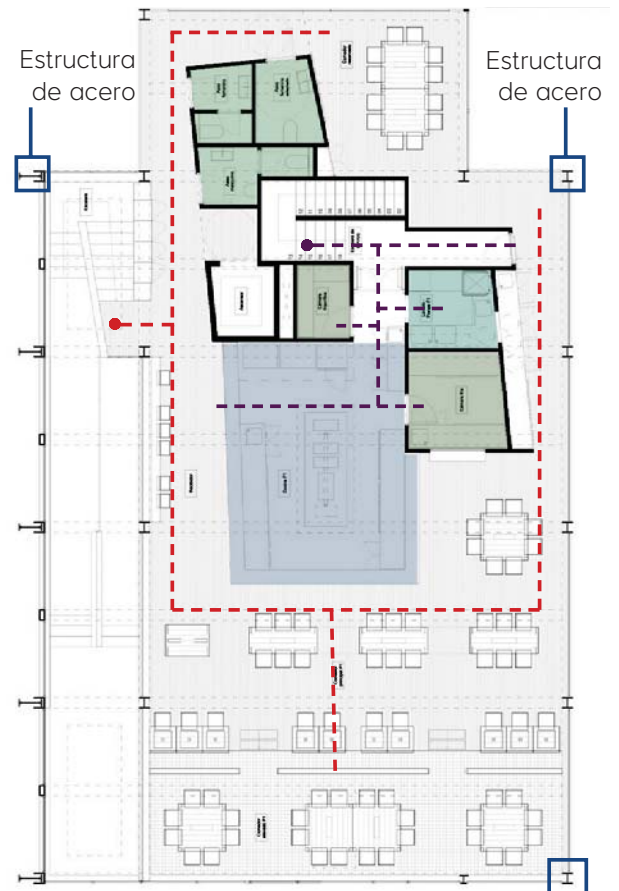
Planta Alta Restaurante Caballa Canalla
